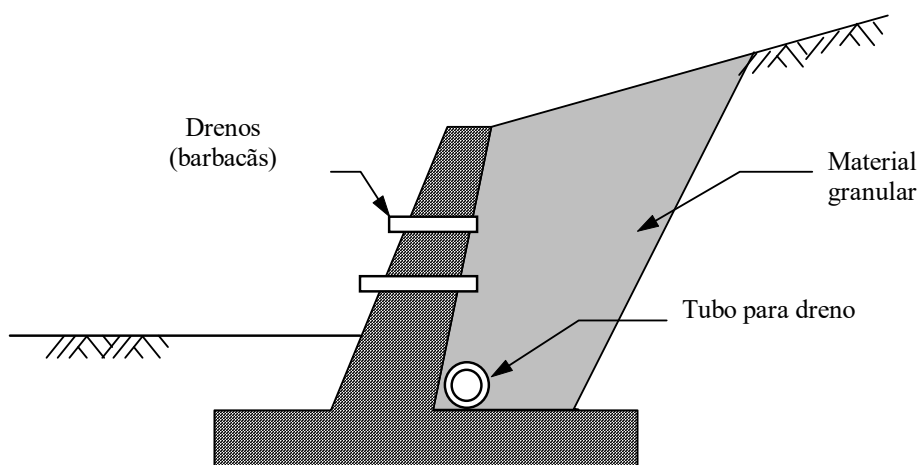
Exemplo de sistema de drenagem em muro de arrimo
